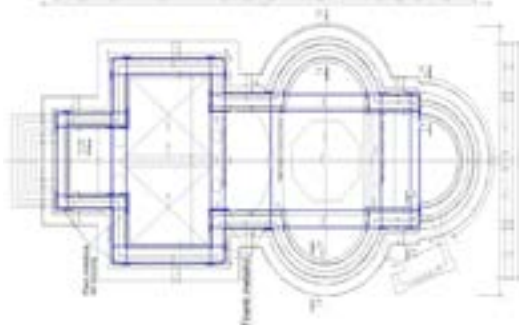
Distribuția în plan a tiranților metalici pentru o construcție din piatră naturală
